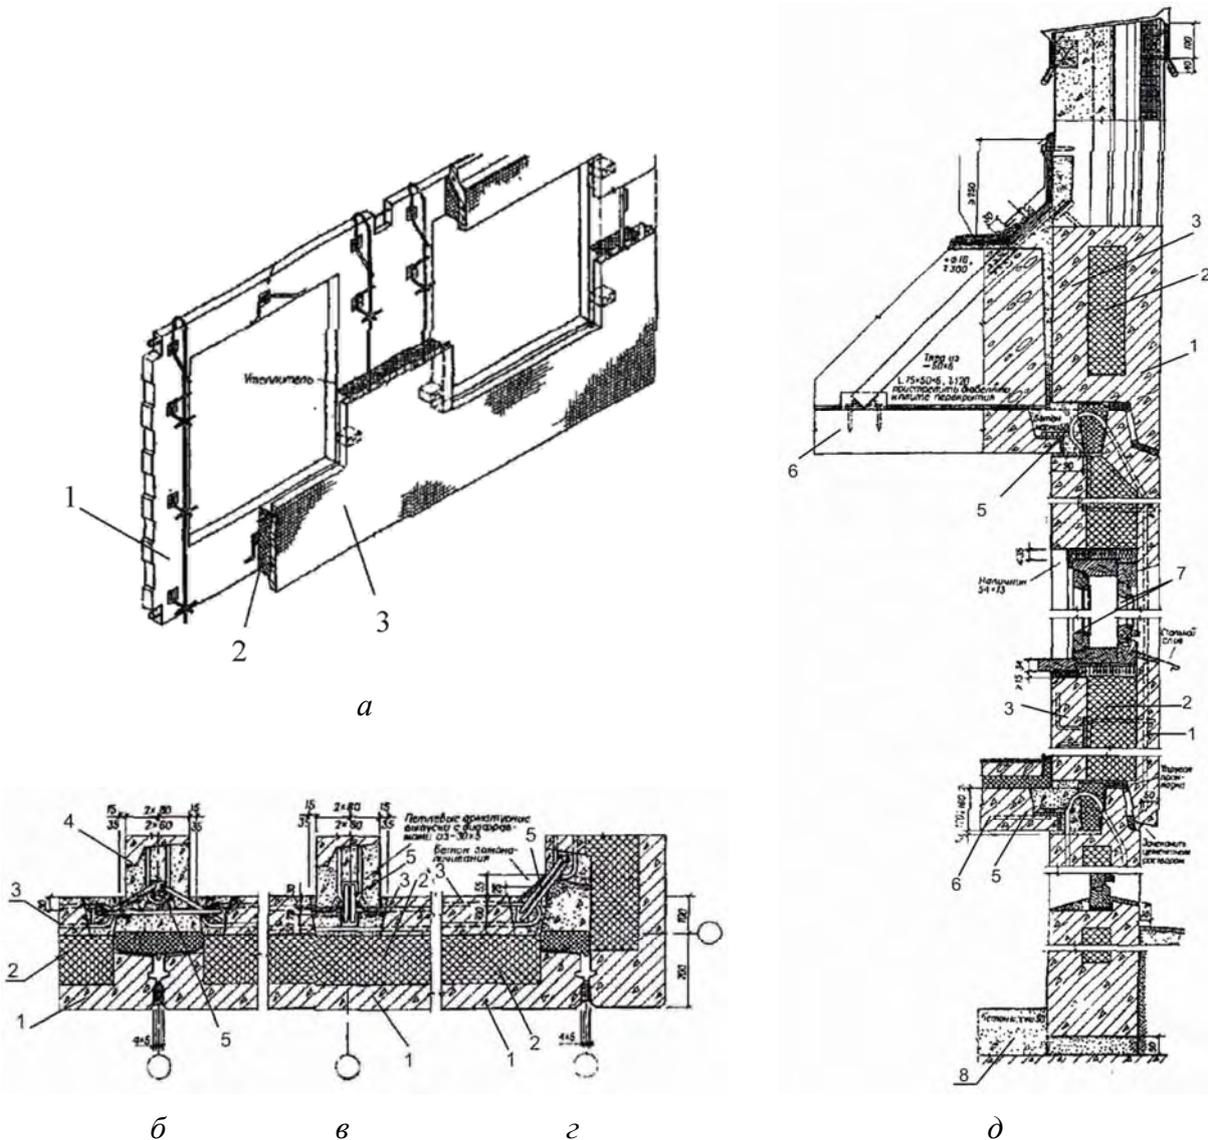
Наружные стены из трехслойных панелей однорядной разрезки зданий высотой до 16 этажей (по серии 1.132-3): *а* — наружная стенная панель на две комнаты; *б* — стык двух наружных и одной внутренней стеновых панелей; *в* — стык наружной и внутренней стеновых панелей; *г* — угловой стык наружных стеновых панелей; *д* — детальный разрез наружной стены: 1 — наружная ж/б скорлупа; 2 — утепленный слой; 3 — закладная петля; 4 — шпонка; 5 — монтажные петли; 6 — плита перекрытия; 7 — оконный блок; 8 — отмоска
